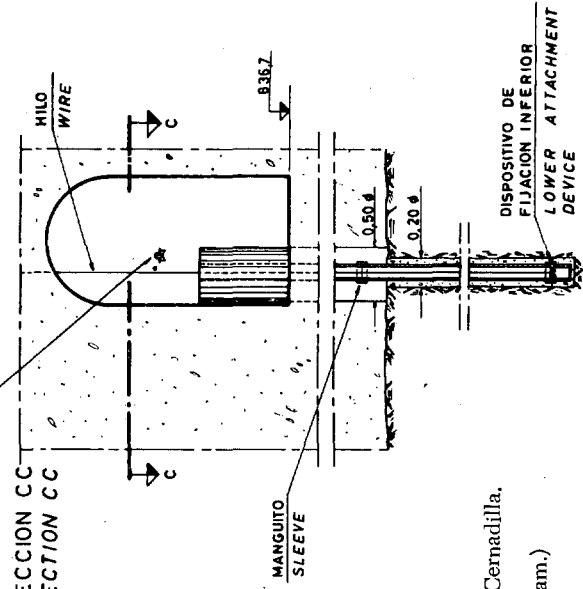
Péndulo invertido montado en el bloque central de la presa de Cernadilla.
